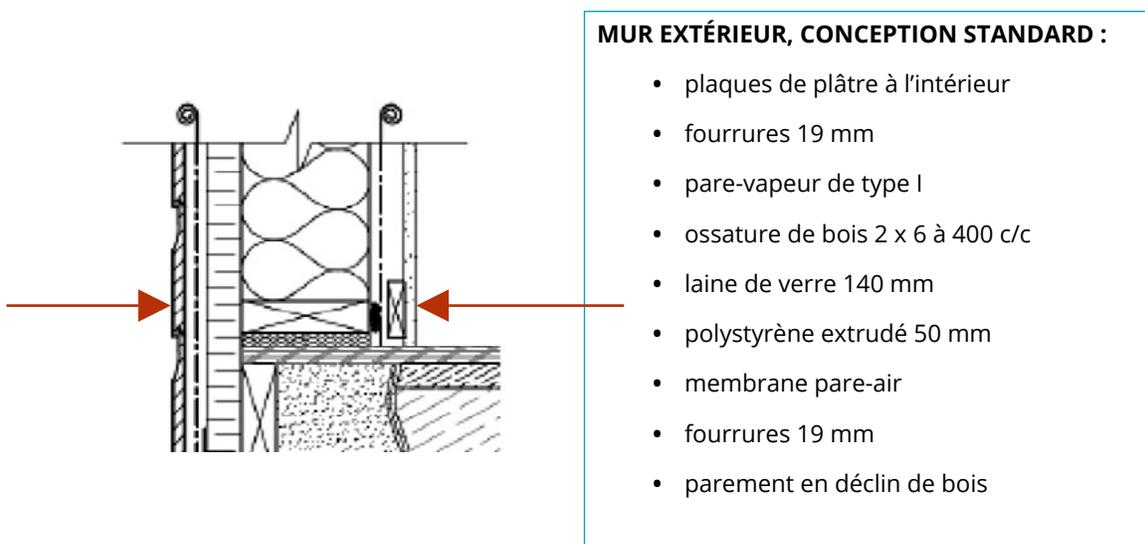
COUPE DE MUR EXTÉRIEUR STANDARD / SOURCE : SHQ
